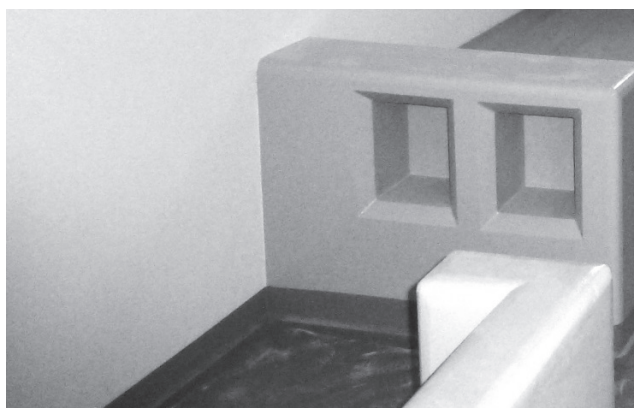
PSR mit Holzauflage auf Betonbett und Einbauregal (Musterraum)
